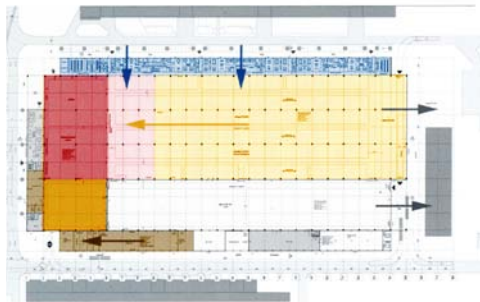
Grundriss [Hemp 08] S. 34
